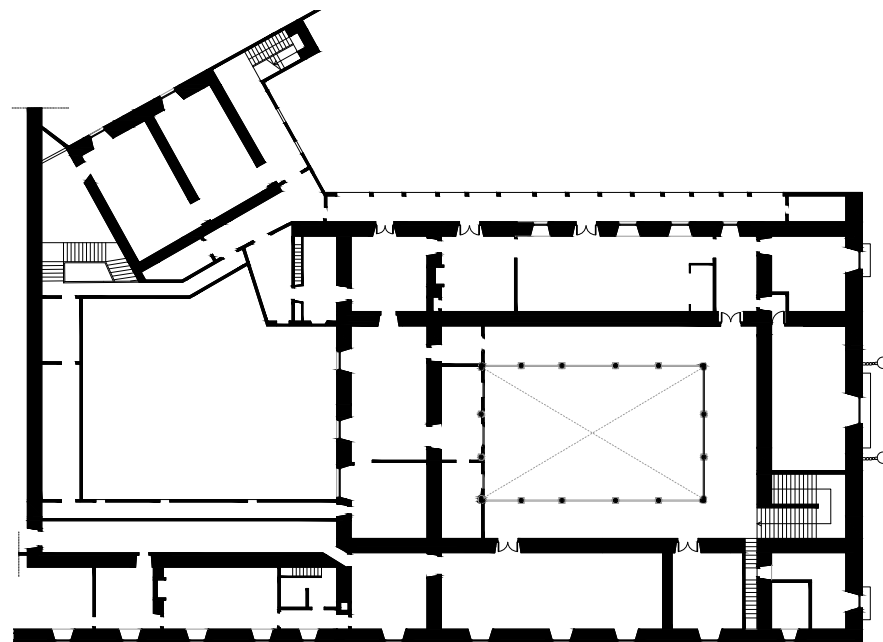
Plano de planta primera de la Chancillería de Valladolid y parte del nuevo Archivo de Chancillería, 29 de mayo de 1626. Elaboración propia.
